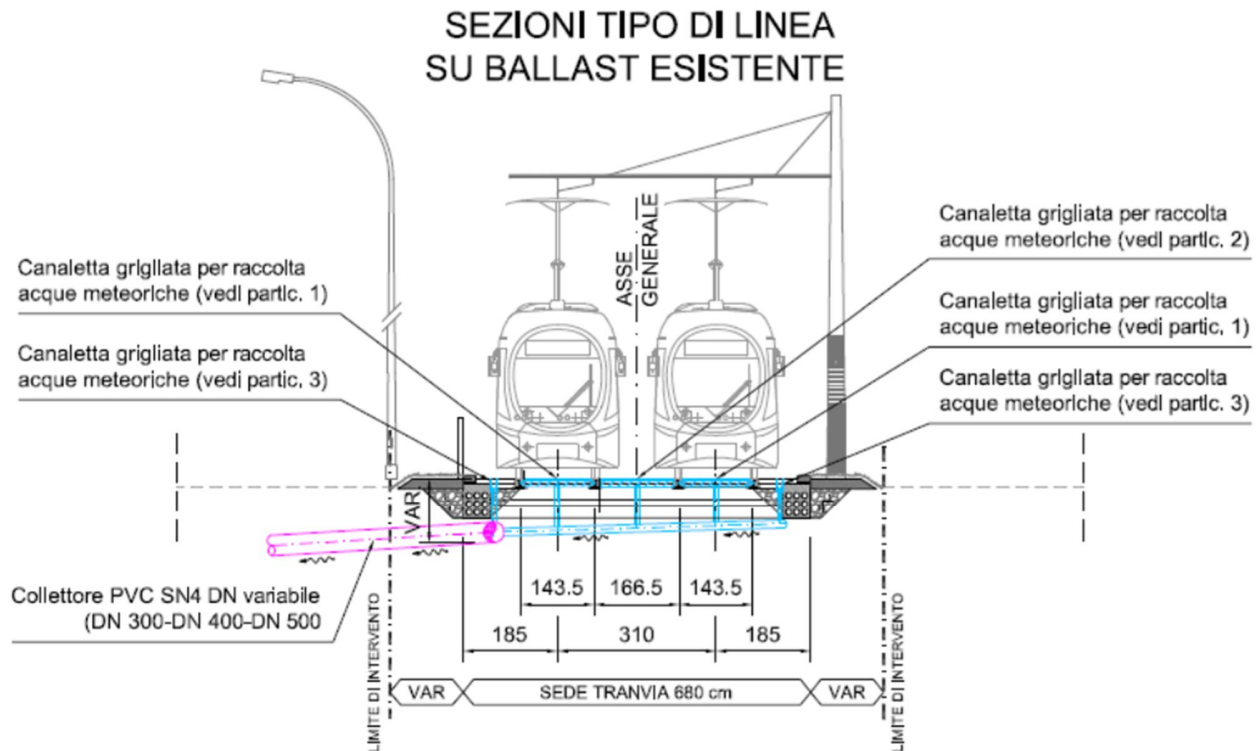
Collettamento acque meteoriche - Sezione tipo di linea su ballast esistente
